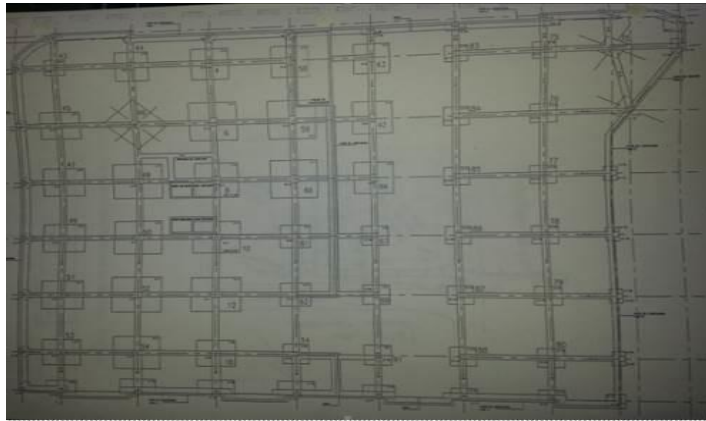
Planta de Cimentación Propuesta (Fotografía de Planos Estructurales)
